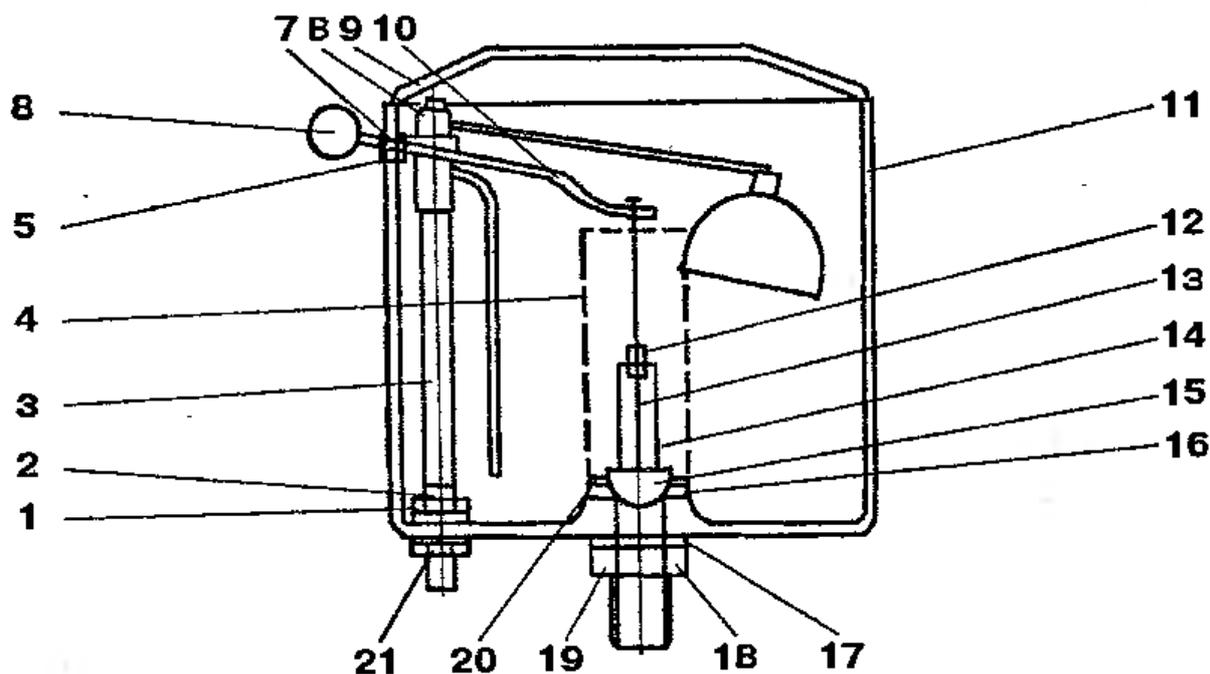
Смывной бачок с нижней подводкой воды: 1 — резиновая прокладка и металлическая шайба; 2, 5, 21 — контргайки; 3 — стойка; 4 — перелив; 6 — ручка; 7 — втулка механизма спуска; 8 — вертикальный поплавковый клапан; 9 — крышка бачка; 10 — рычаг; 11 — корпус бачка; 12 — втулка; 13 — тяга; 14 — дуга; 15 — груша; 16 — резиновая прокладка седла; 17 — резиновая прокладка; 18 — металлическая шайба; 19 — гайка седла; 20 — седло
